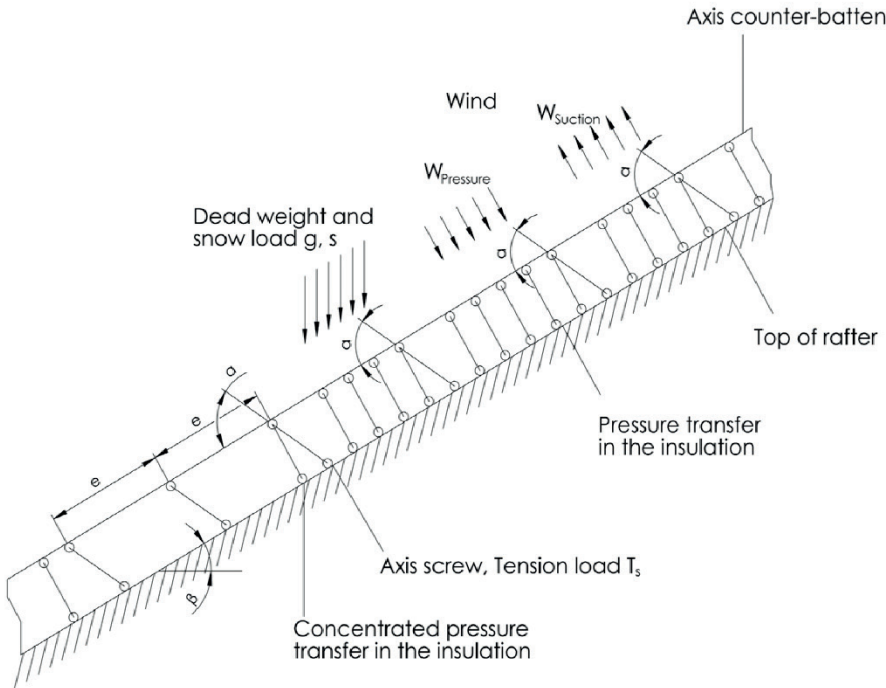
Mise en œuvre d'un isolant thermique sur des chevrons - système structural pour vis inclinées parallèlement
